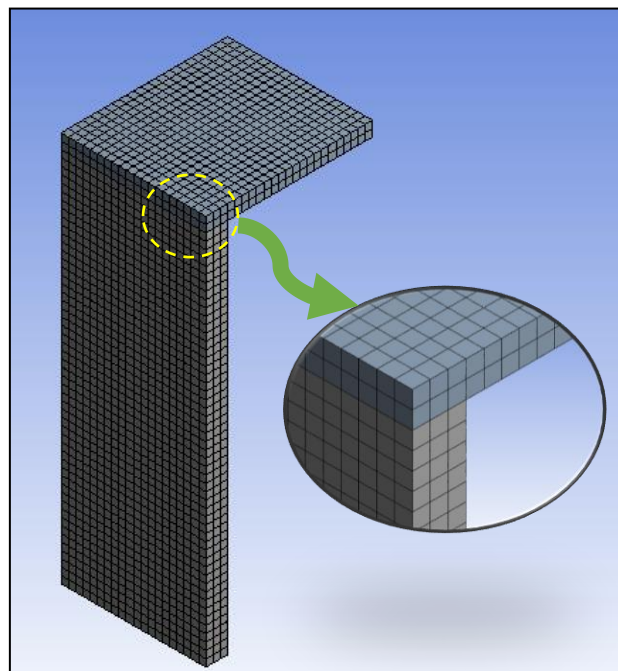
Malha de elementos finitos para um conjunto laje-parede (1 pavimento).
